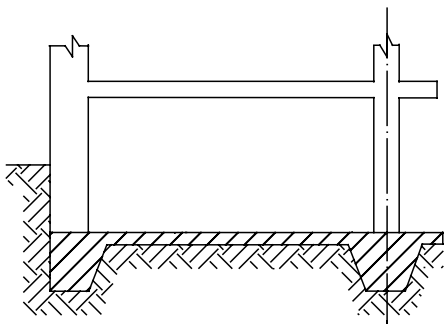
Сплошной барьер (фундаментная плита переменного сечения)
